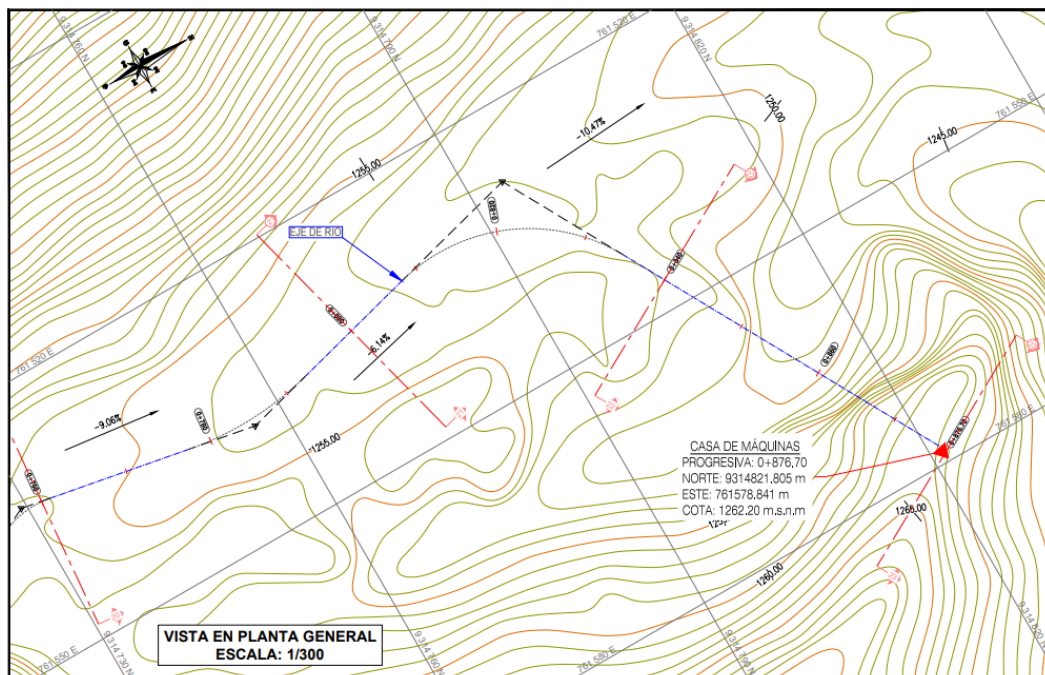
Vista en Planta de la topografía en la zona de Casa de Maquinas
